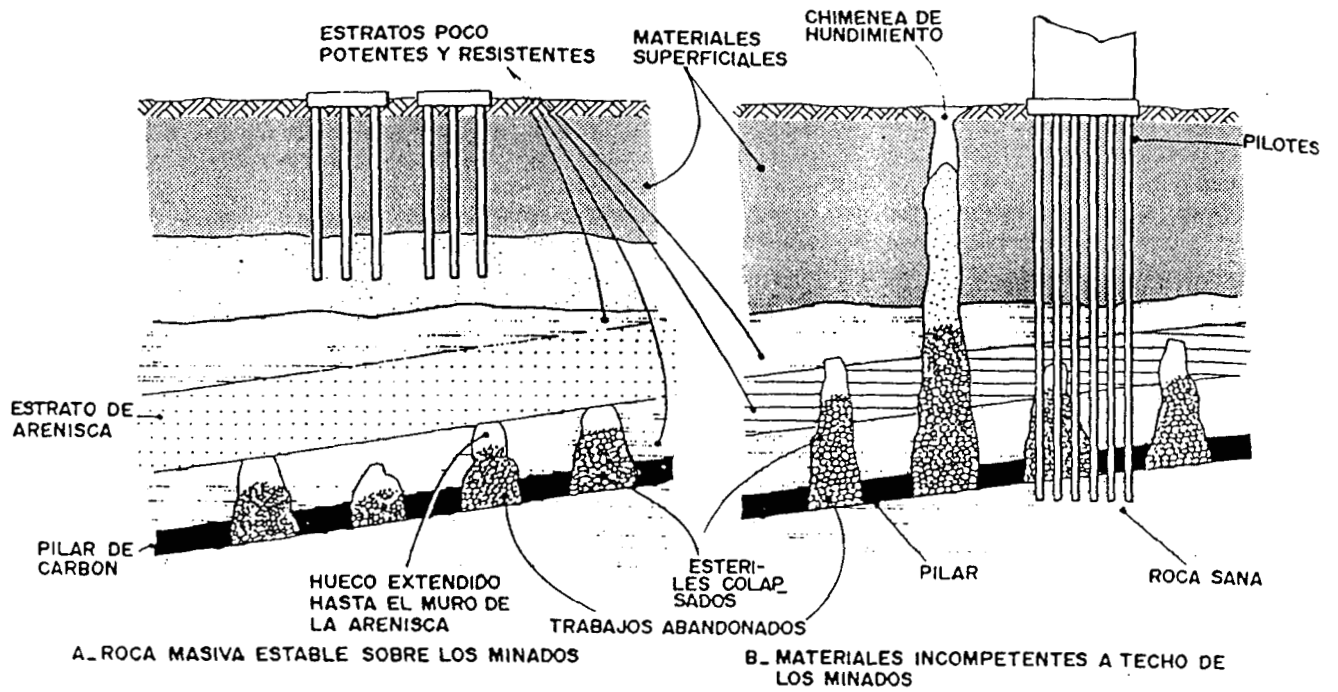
Empleo de pilotes para la cimentación de estructuras. (Tomlinson, M. J., 1980)
